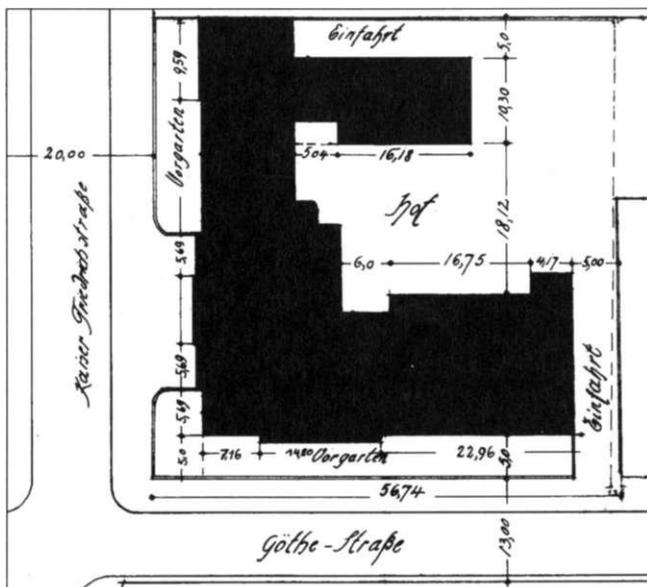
Lageplan Gerhart-Hauptmann-Straße 16
